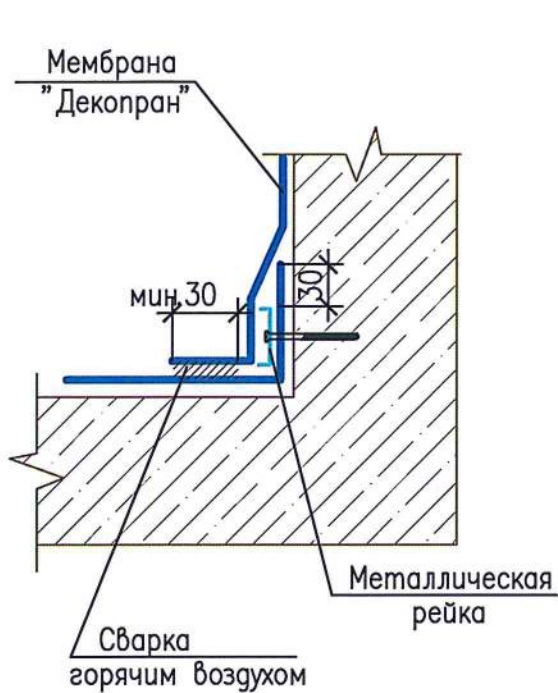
Механическое закрепление к железобетонному основанию. Варианты крепления мембраны в местах примыкания
